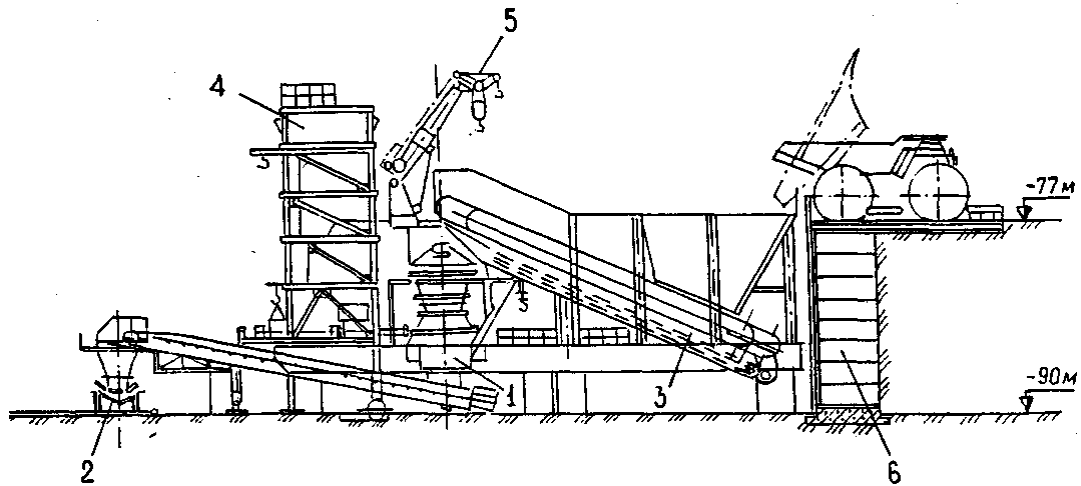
Схема дробильно-перевантажувального пункту з пересувною дробаркою фірми "KRUPP": 1 - дробарка; 2 – похилий стрічковий конвеєр; 3 – пластинчастий живильник для завантаження дробарки; 4 – пульт управління; 5 – підйомний кран; 6 – опорна стінка
